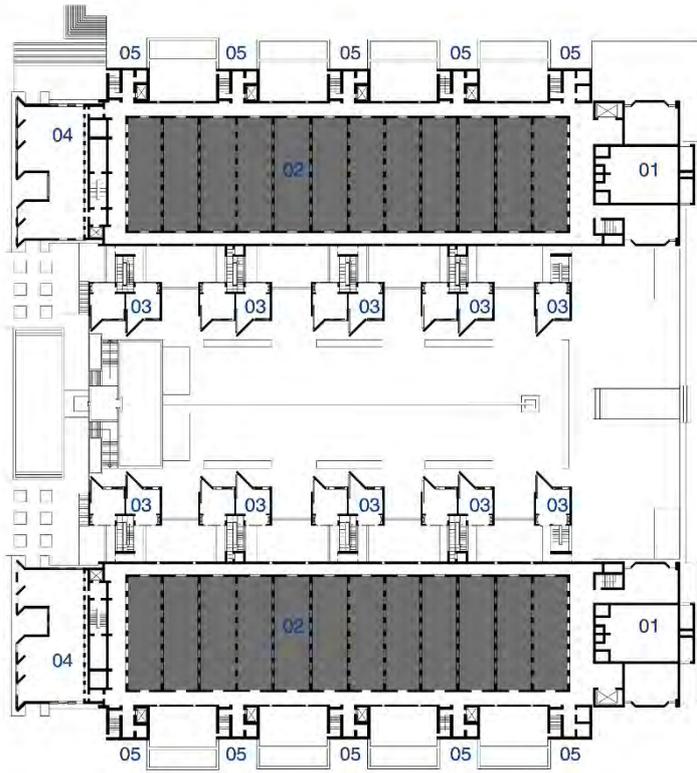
| Planta nível +1 e +3 (ESTÚDIOS E INSTALAÇÕES) [redesenho do autor]
